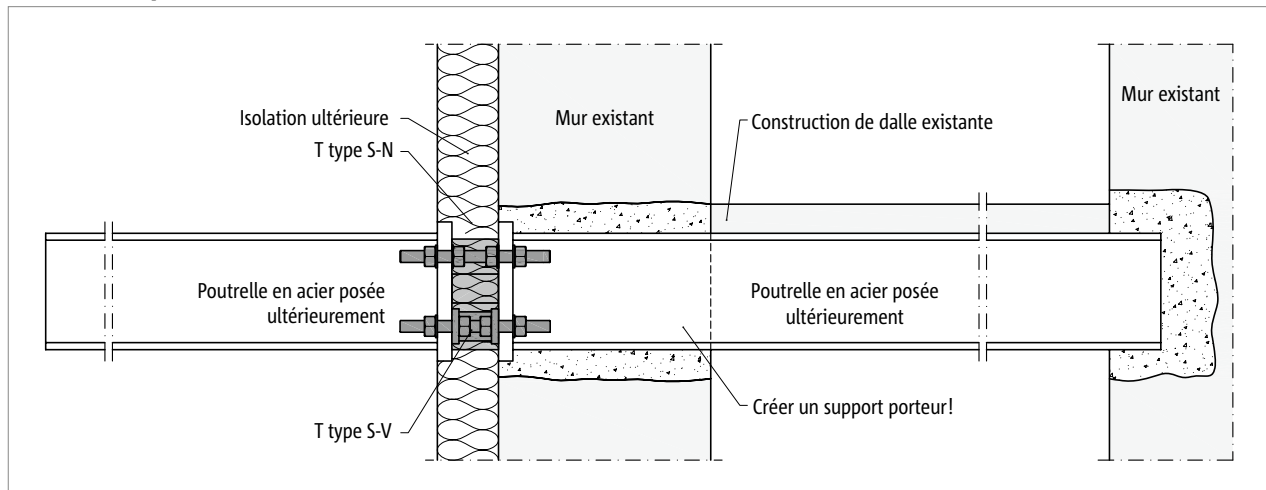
Schöck Isokorb® T type S-N et T type S-V : balcon en acier en porte-à-faux libre posé ultérieurement ; raccordé à des poutres en acier installées ultérieurement
